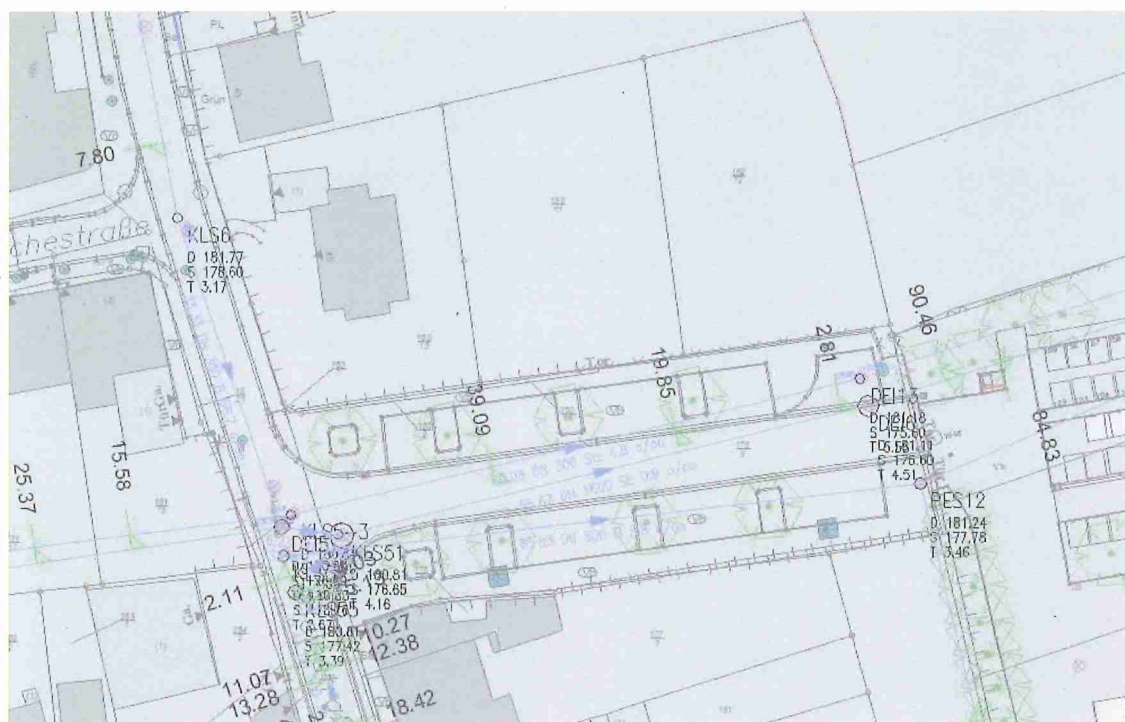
Erschließungsplan, Tiefbauamt der Kreisstadt Saarlouis
